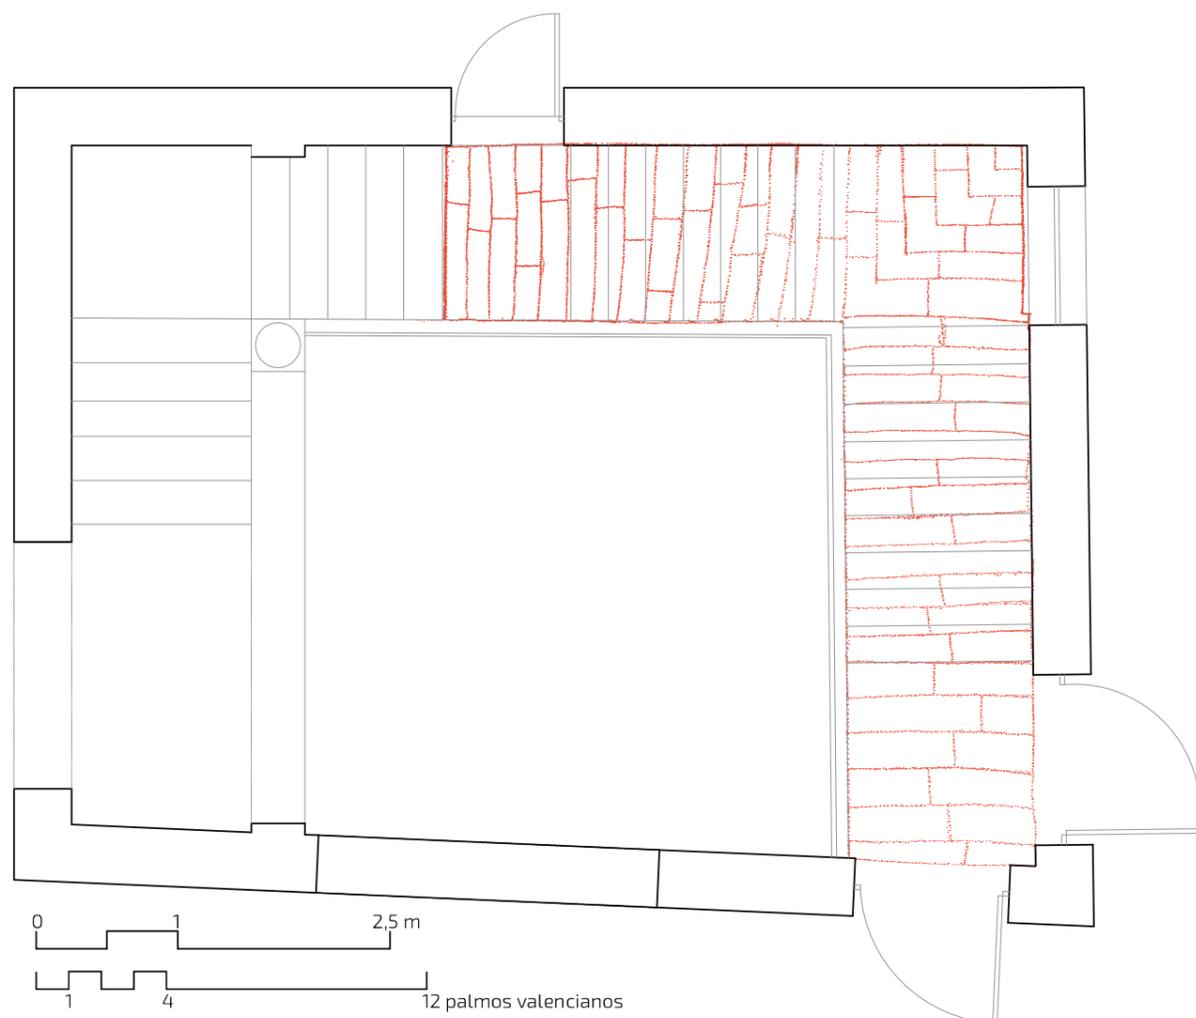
Levantamiento patio y alzado escalera con la nube de puntos sacada por Cyclone (en rojo)
